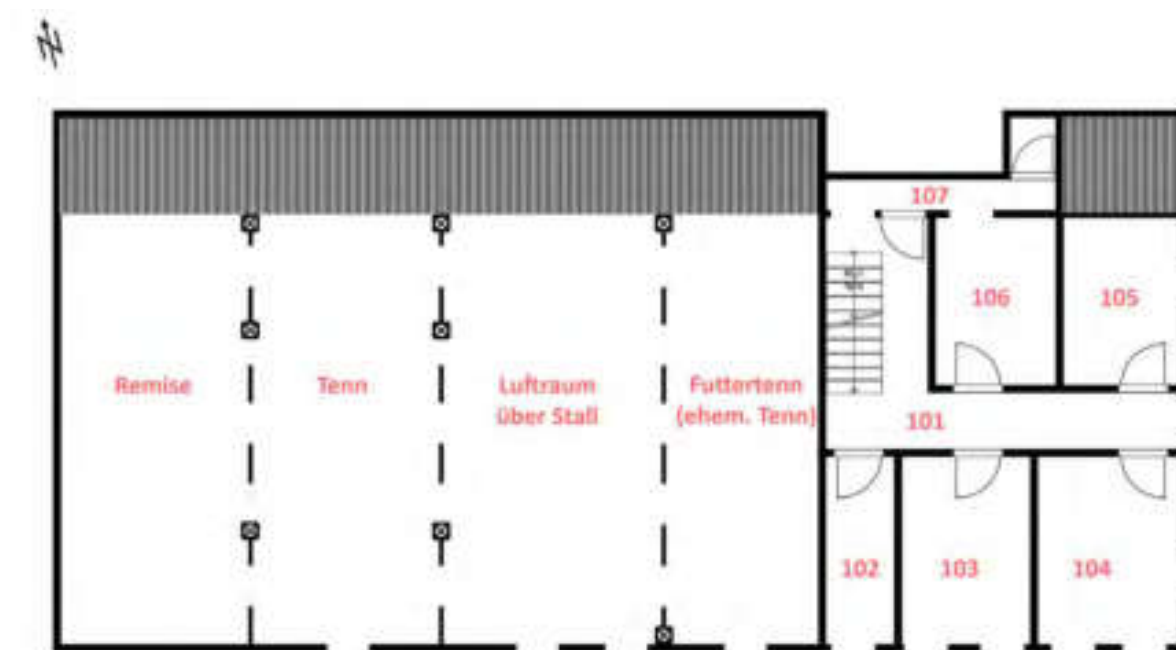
Schematischer Grundriss Obergeschoss, Bearbeitung IBID.
